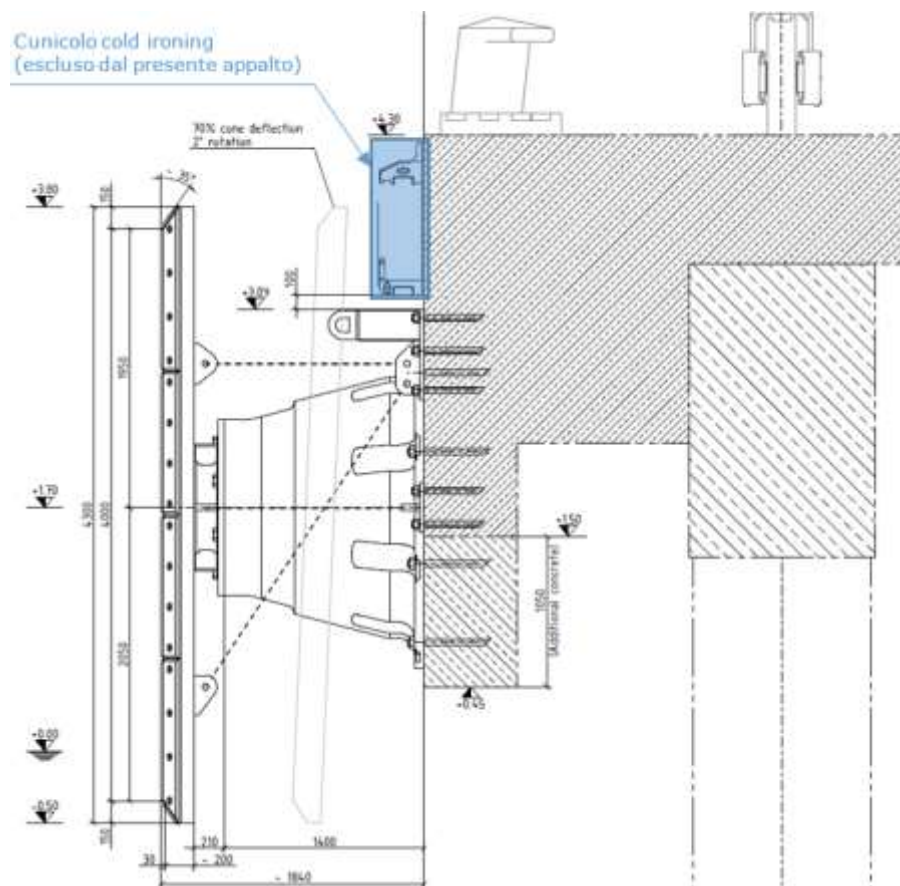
Sezione tipica della banchina con in evidenza la posizione dei parabordi
